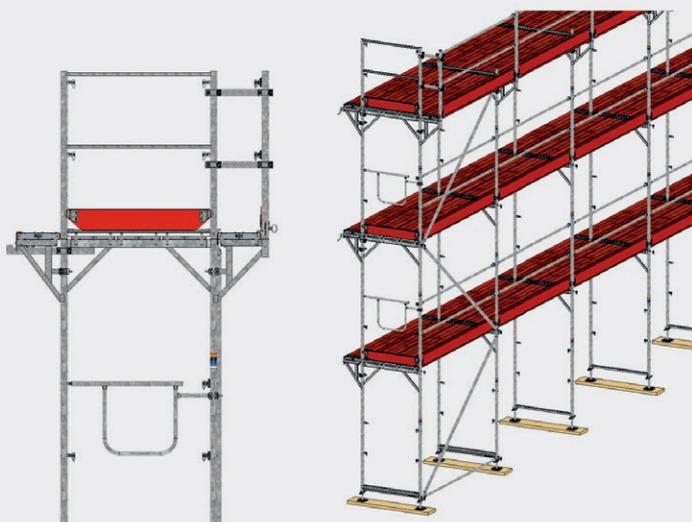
Леса с наружными расширяющими кронштейнами на один элемент настила
